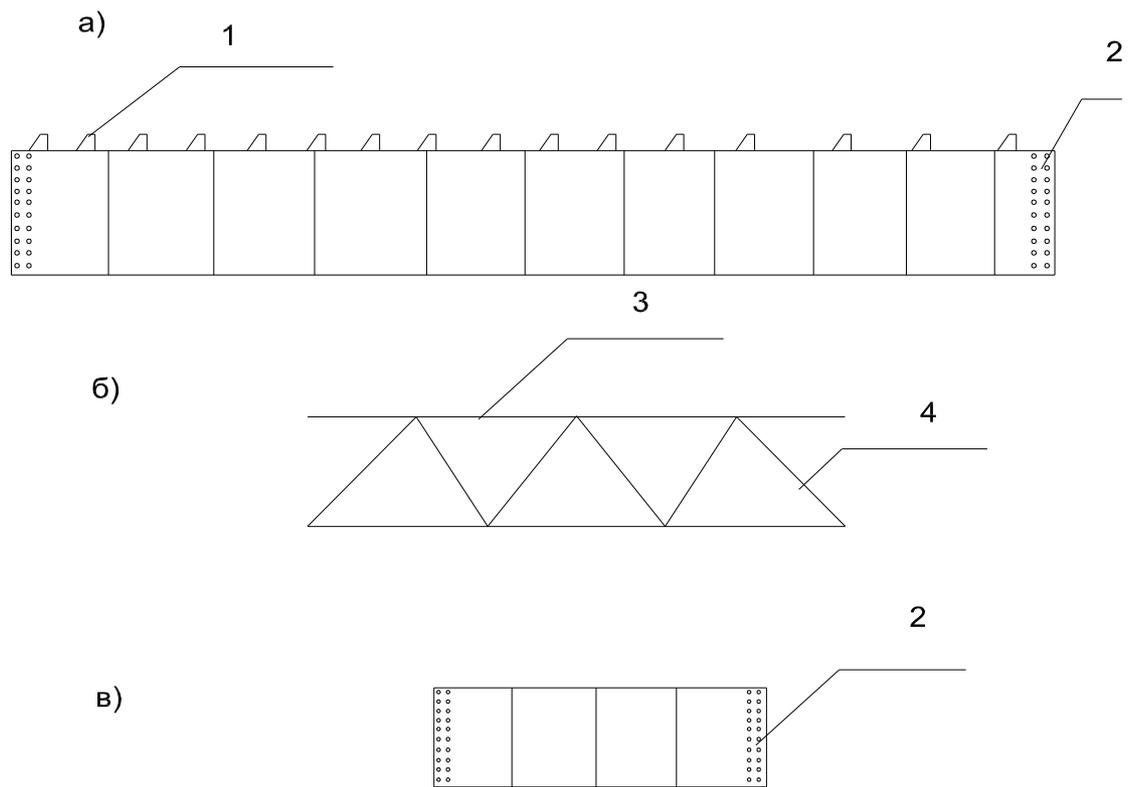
Основные заводские блоки стальных балок типовых сталежелезобетонных пролетных строений: а-блок главной балки с приваренными жесткими упорами; б-блок сквозных поперечных связей в виде сварной фермы из уголков; в-блок сплошнотенчатой надпорной диафрагмы; 1-жесткие упоры; 2-отверстия в стенке для установки высокопрочных болтов монтажных стыков; 3-уголки поясов сварных ферм поперечных связей; 4-раскосы из уголков
